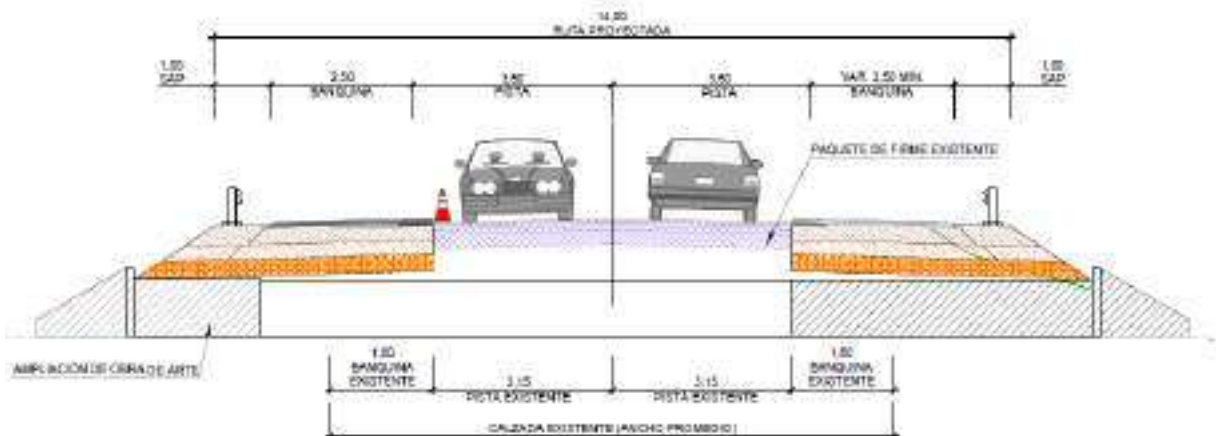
Detalle tipo para zonas de obra y tránsito en fase 2 de Desvíos Tipo III.
